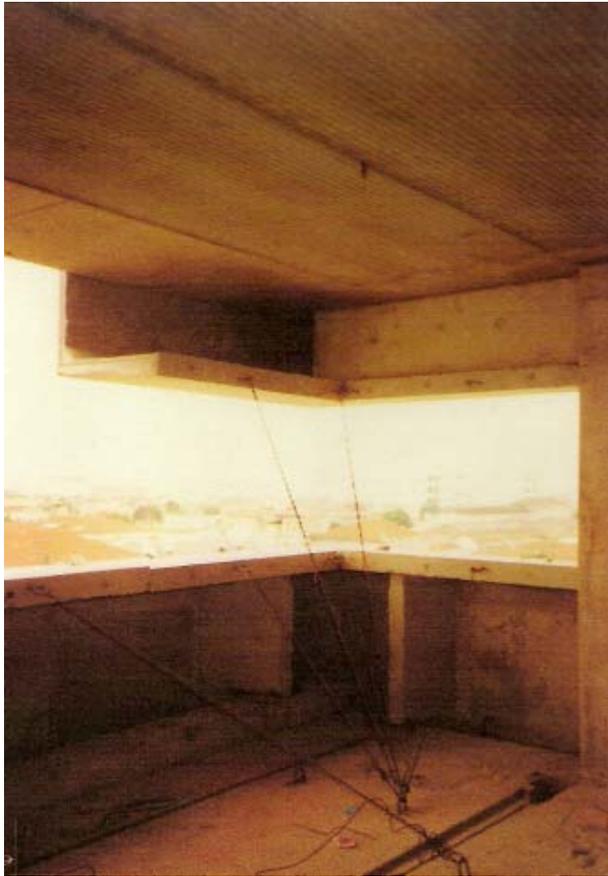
Caixa Lateral e Laje pré-moldada com as canaletas embutidas, em execução.
